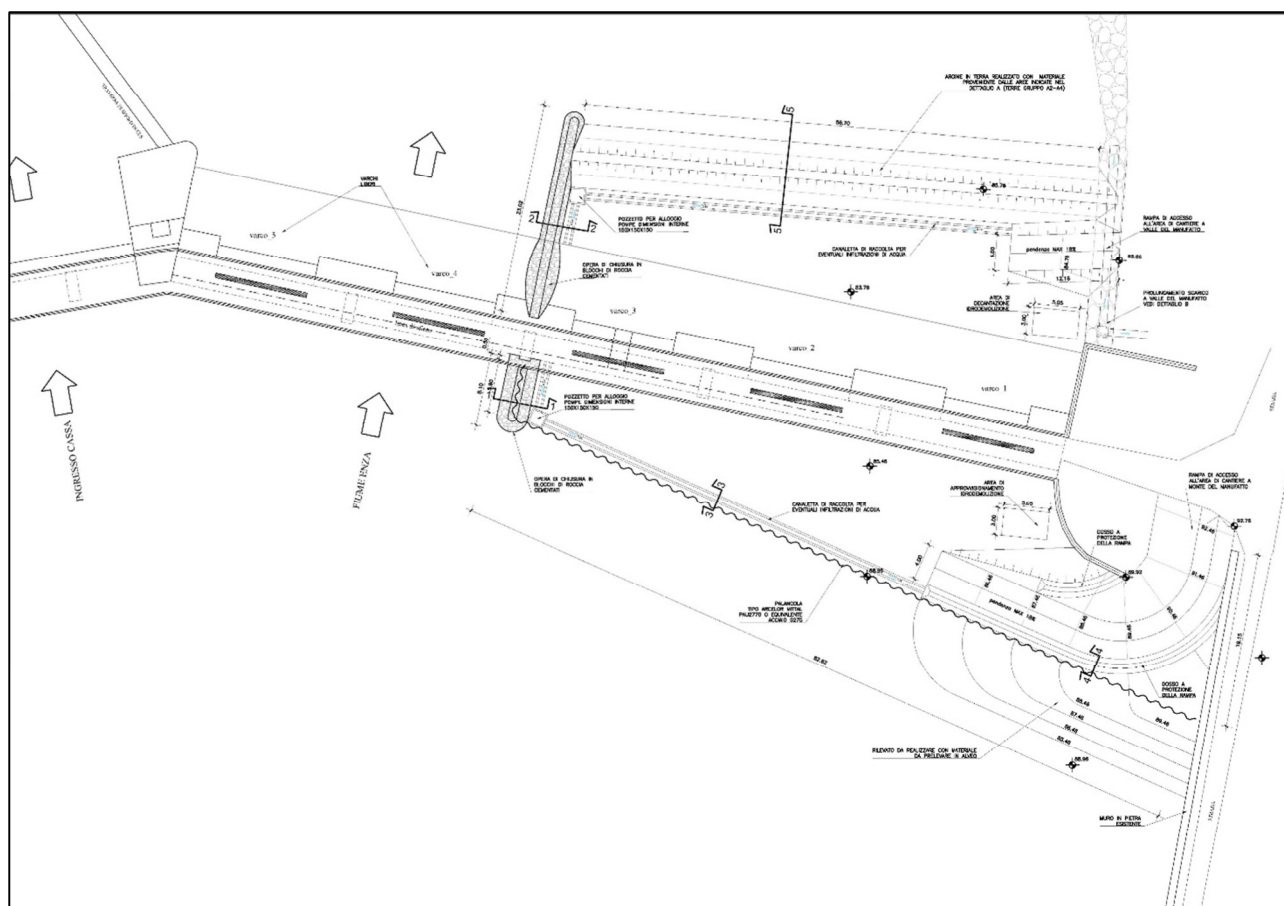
Opere Provvisorie - Stagione 1 - Planimetria
